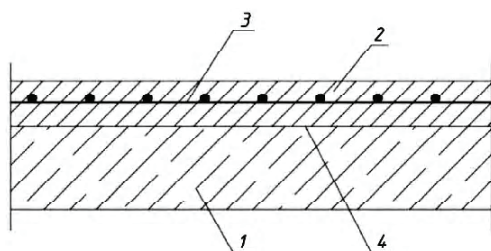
Нарастивание монолитного слоя сверху: 1 – усиваемая плита; 2 – монолитный слой бетона; 3 – арматурная сетка; 4 – поверхность сцепления монолитного бетона с плитой.
